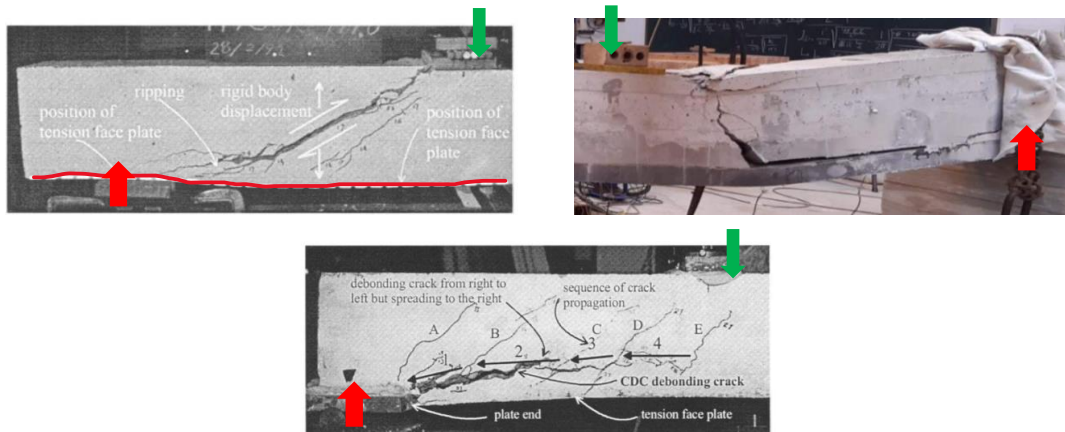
Formas de rotura similares por inicio de fisuración por cortante: (a) refuerzo con platabanda (b) RCSM y viga de hormigón armado sin estribos (c).
